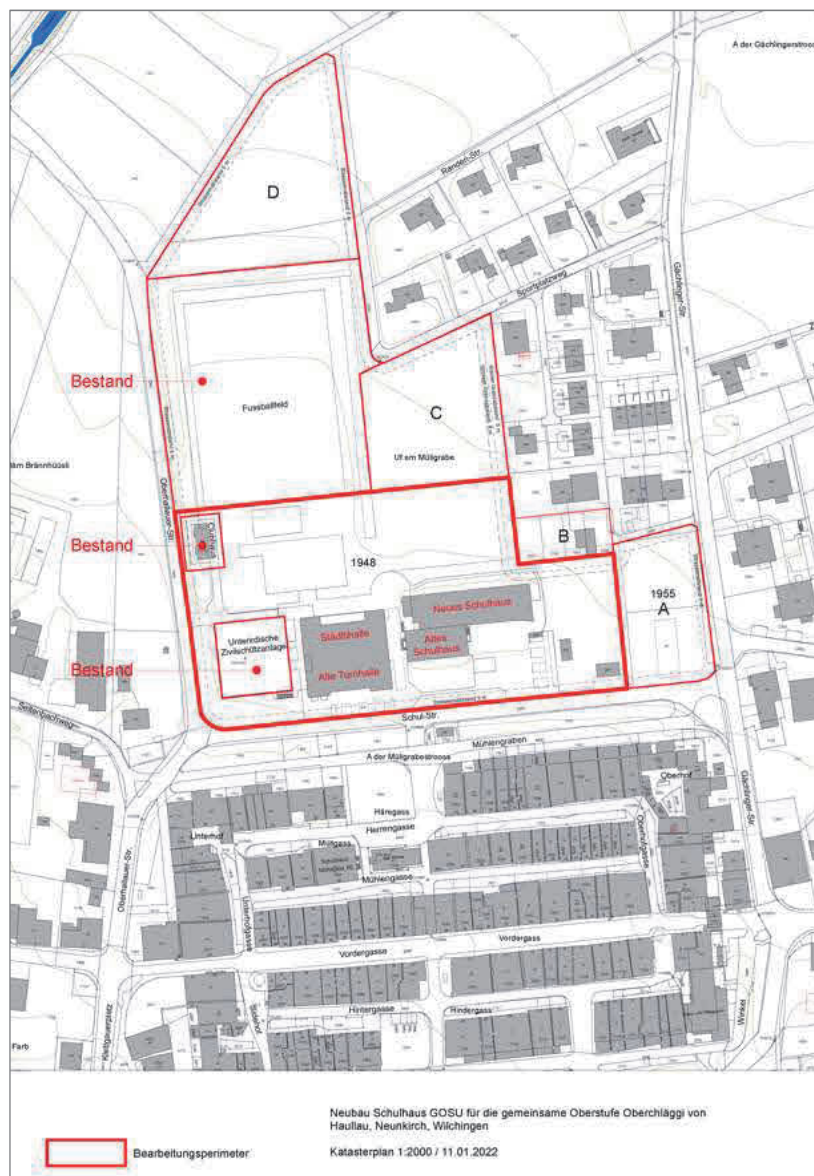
Projektierungsperimeter des Studienauftrages für den Schulhausneubau
